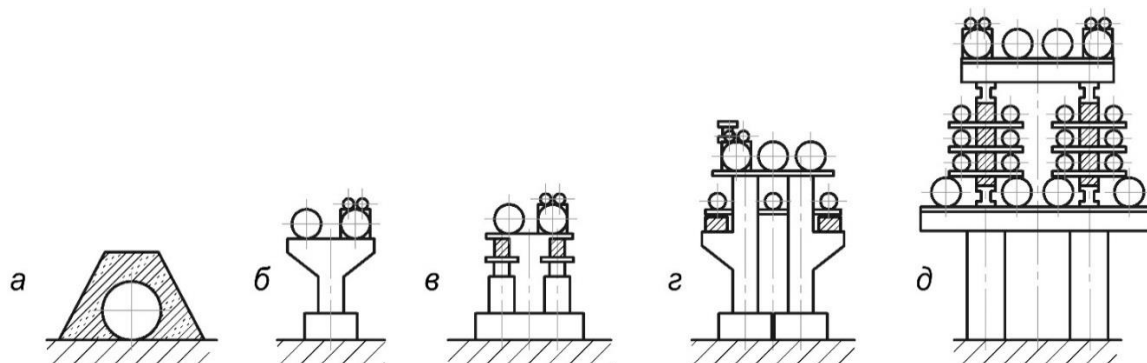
Схемы организации надземной прокладки технологических трубопроводов [1]: а – на грунте; б - на отдельно стоящей стойке; в – на одноярусной блочной стойке; г – на многоярусной блочной стойке; д – на стойке ферменного типа
